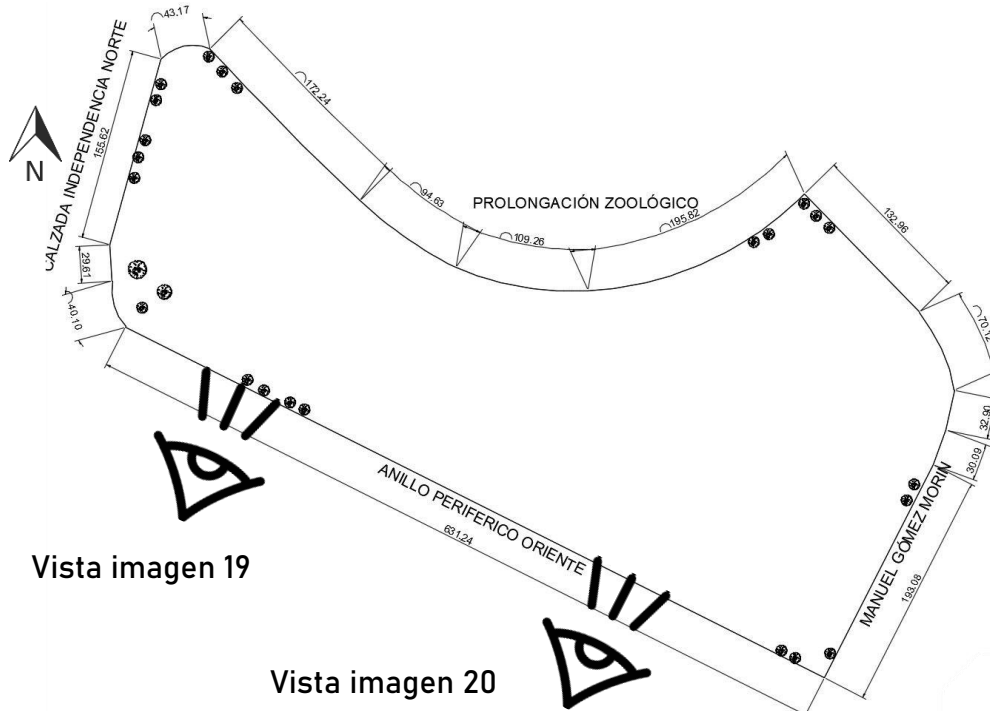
Vista en planta del predio, referencias a imagen 19 y 20.
